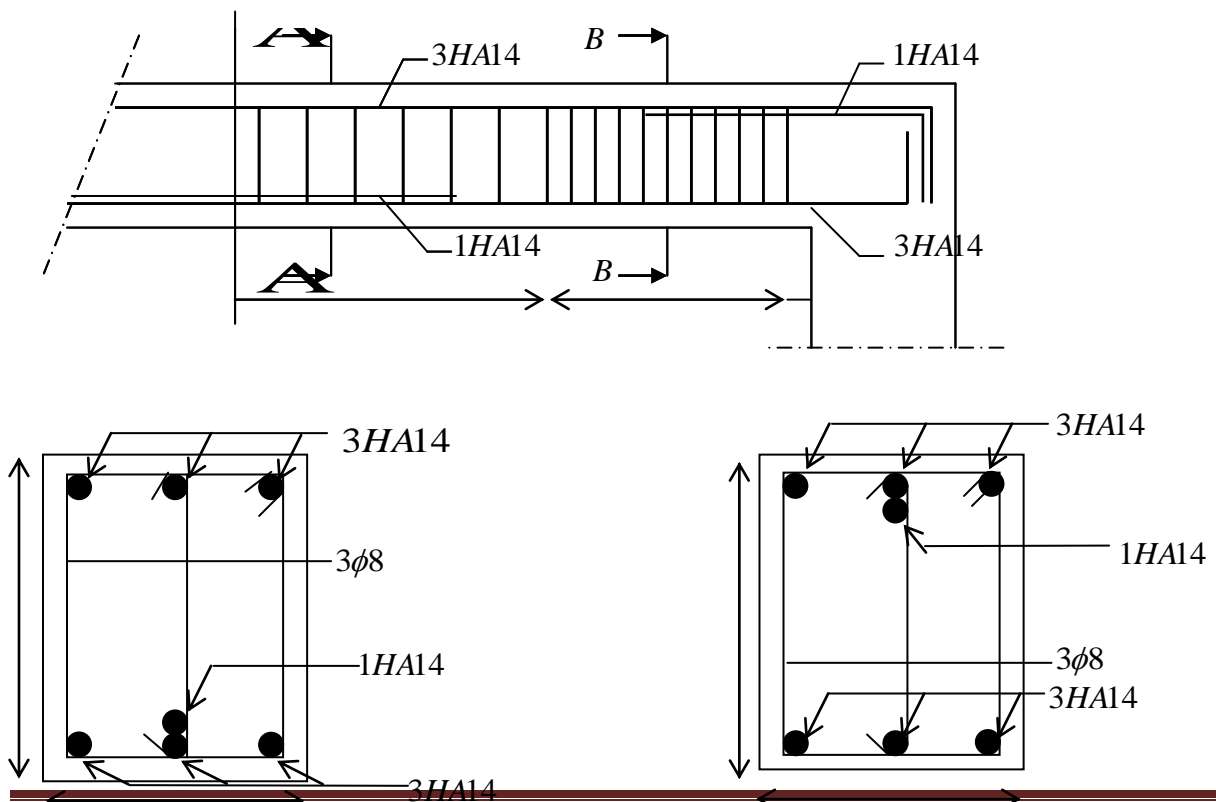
Ferrailage de poutre Secondaire
